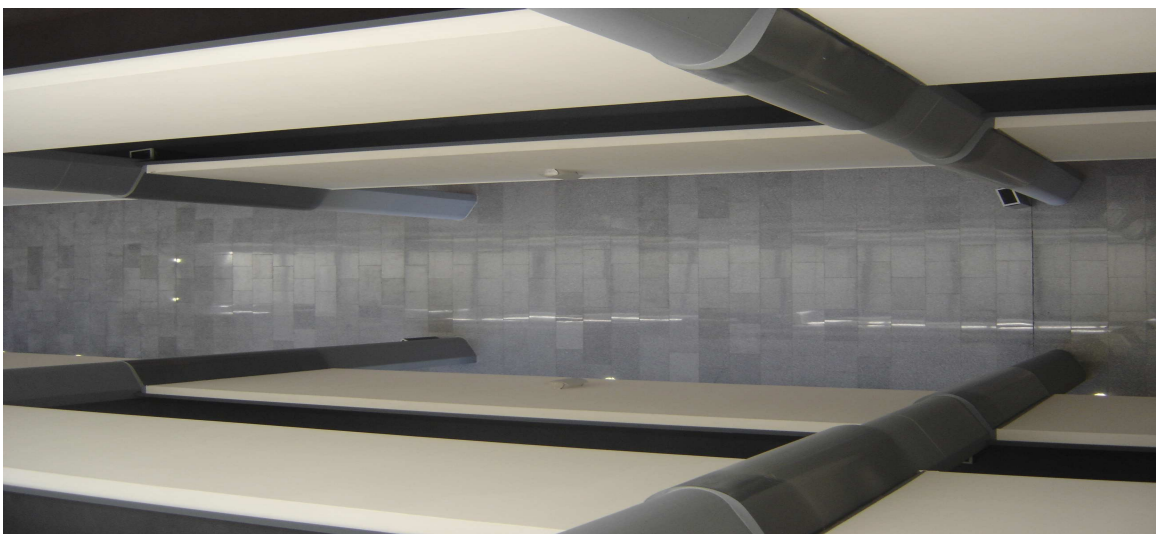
b: Vista de planta del pasillo de la planta baja del edificio C de la EPS.
